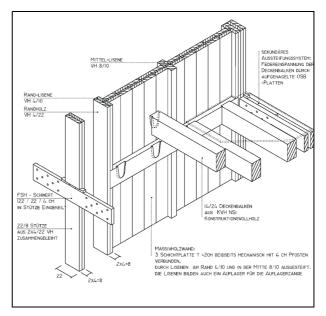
Montage Rohbau Knoten Wand – Decke mit Skelettstütze
